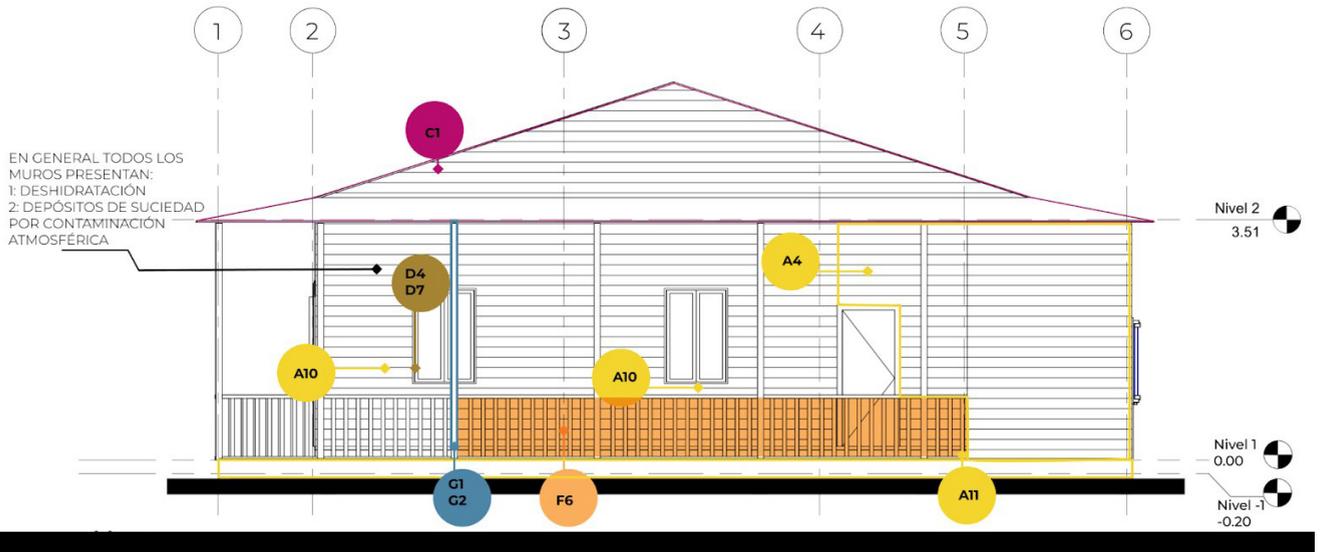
Planos de lesiones. Vivienda pareada (M-Tipo 1-01). Elevación principal. Fuente: Garay (2021).
